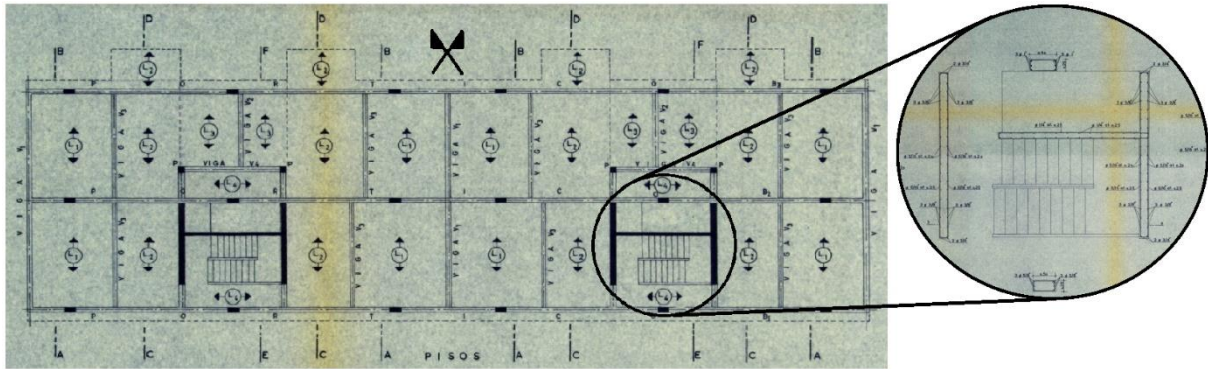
Peças desenhadas[13]: Planta de Estruturas dos pisos correntes com pormenor das paredes estruturais
